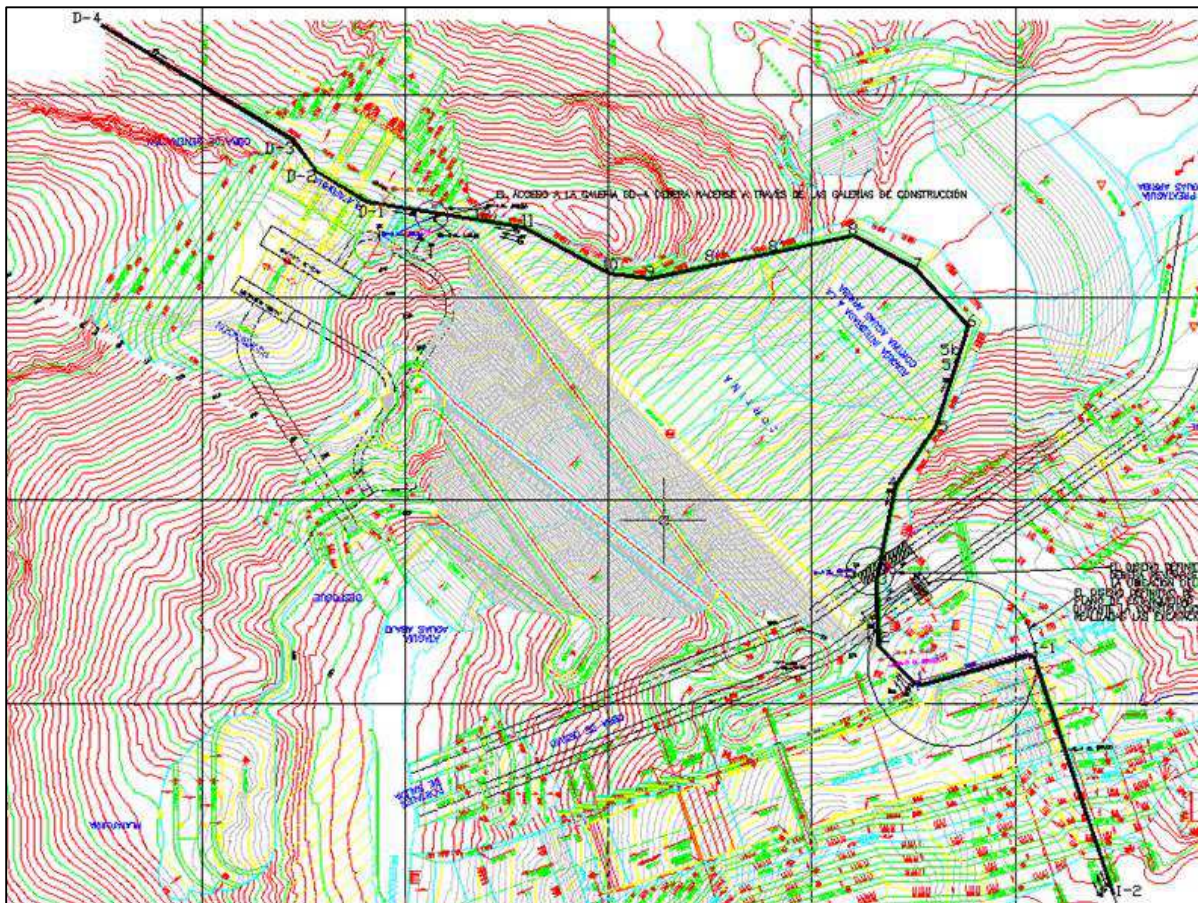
Planta de delimitación del Plano de Estanqueidad.
